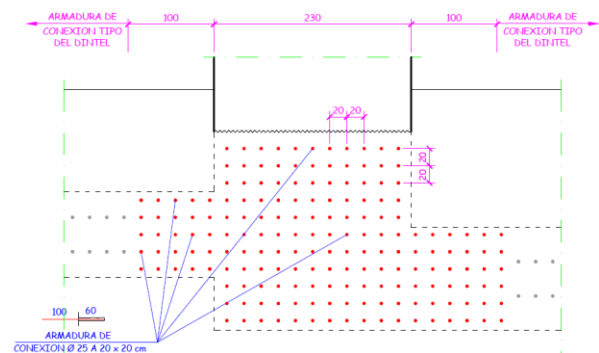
Refuerzo de conexión de armadura a pantallas en empotramiento de pilas.
